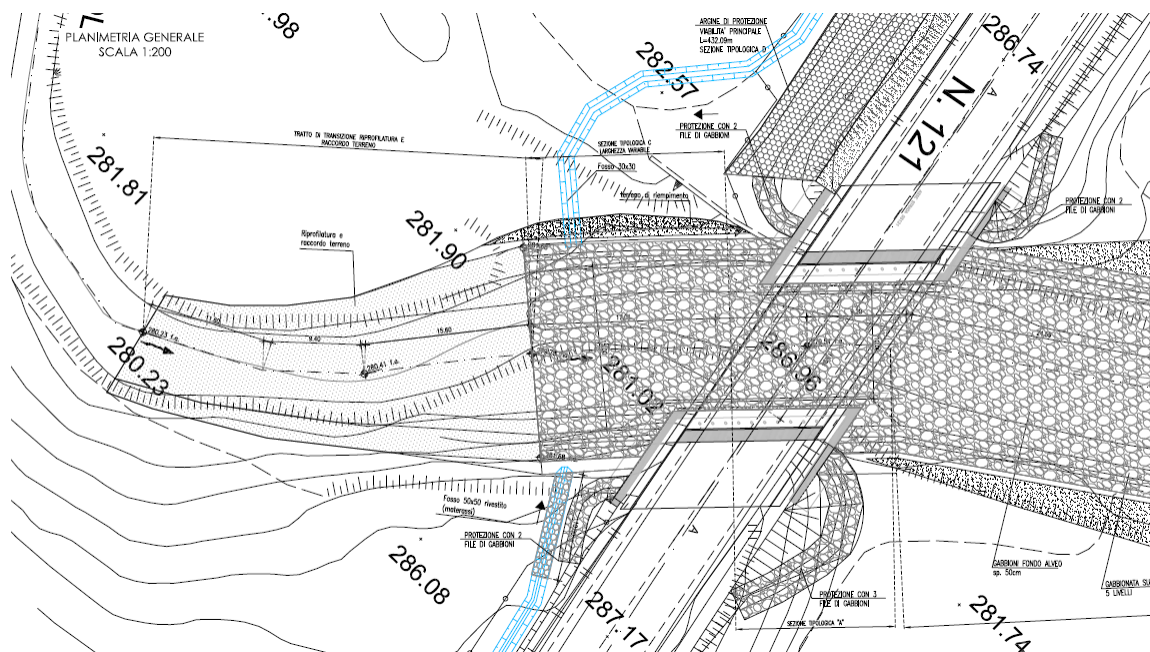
Planimetria generale (1/2) in corrispondenza della SF13.
